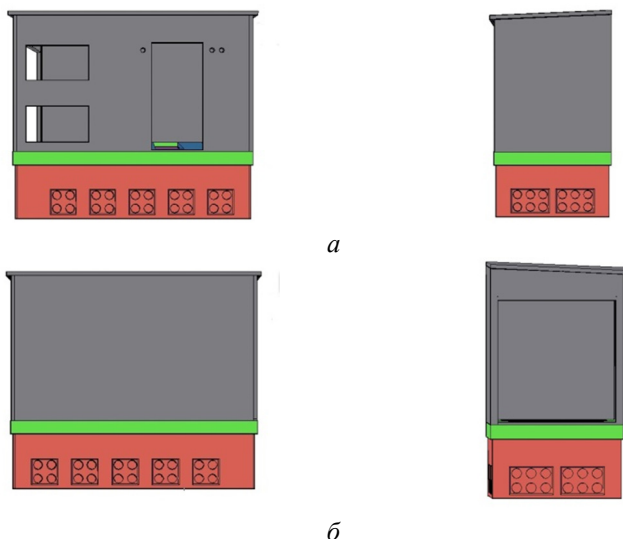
а* – внешние стенки 3D CAD модели корпуса блочной комплектной подстанции; *б* – внешние стенки 3D CAD модели корпуса блочной комплектной подстанции
